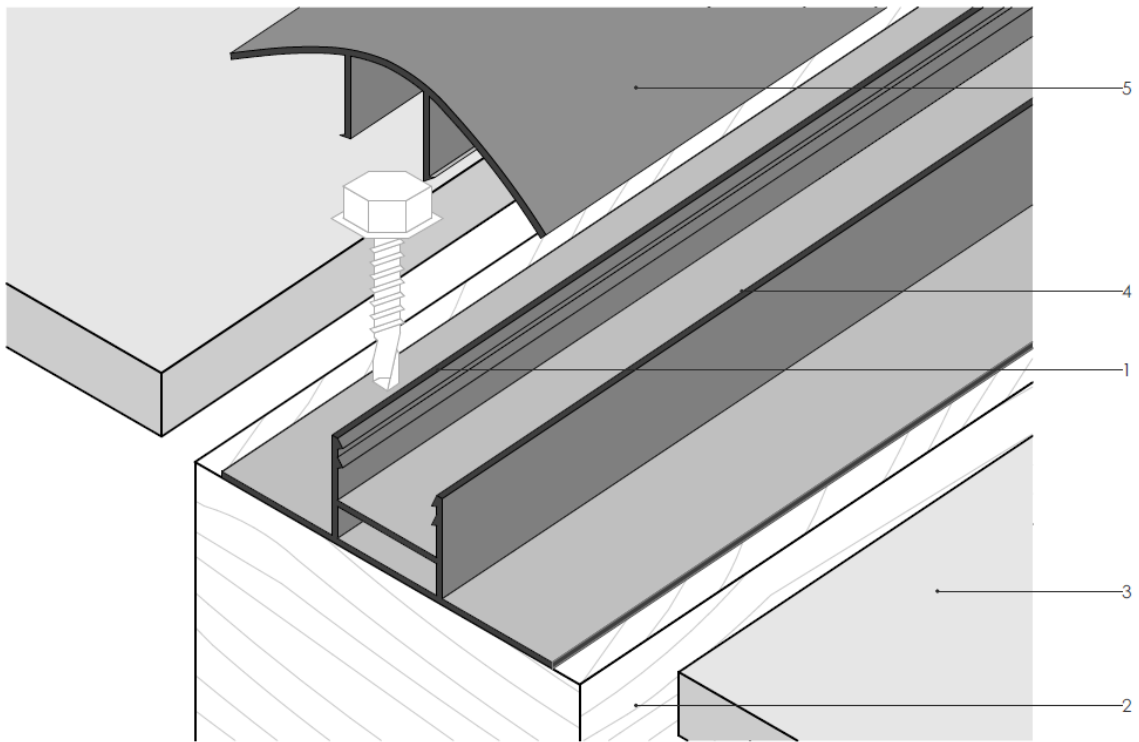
SECCIÓN CONSTRUCTIVA 01. FUENTE: PROPIA
